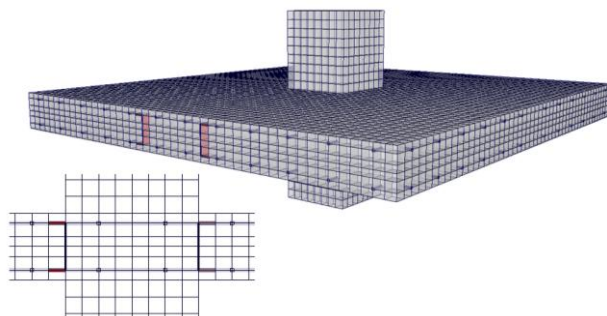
Фрагмент уточненной модели узла сопряжения колонны и плиты перекрытия с жёсткой арматуры в виде двух швеллеров №14
